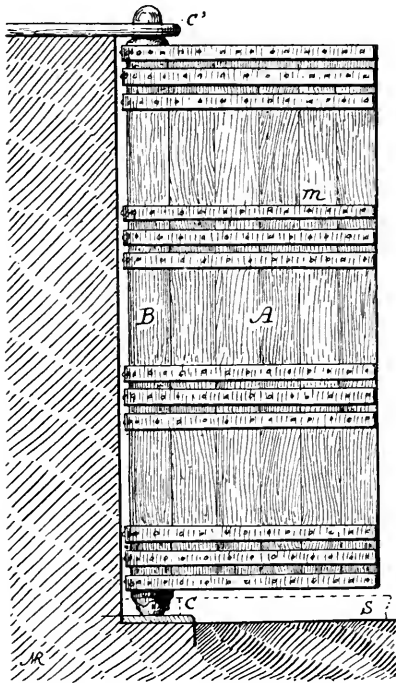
Vantail de porte (restauration d'après les Portes de Balawât).
